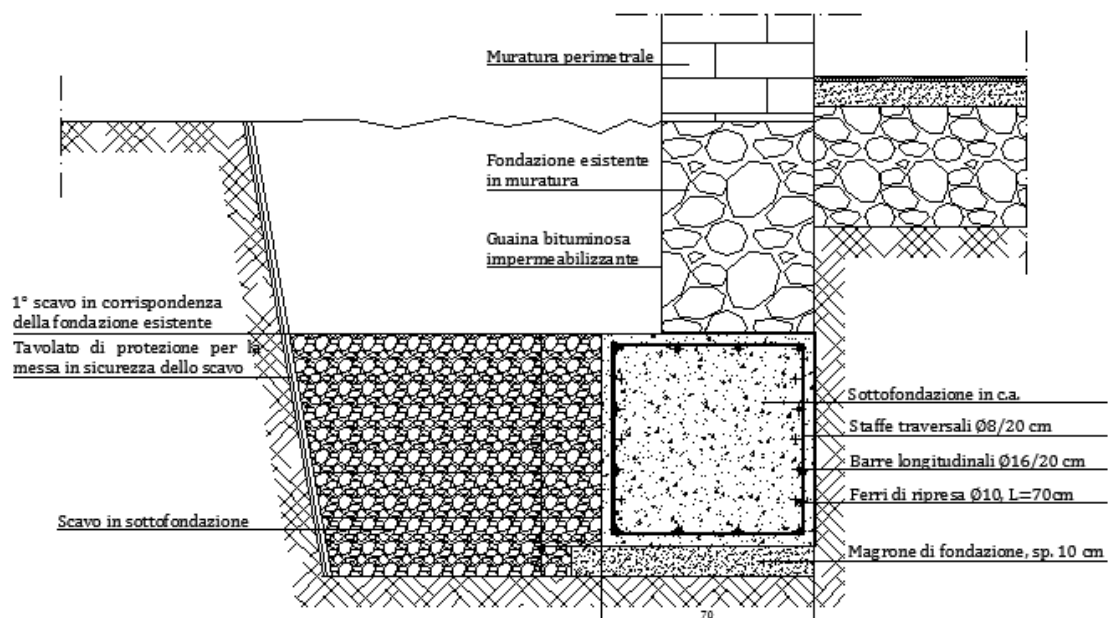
Sezione trasversale delle sottofondazioni in c.a.
